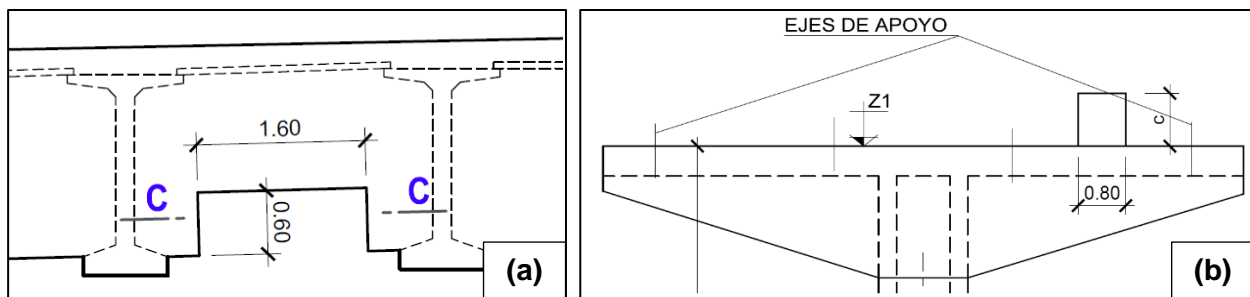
Detalles para el tope sísmico mostrados en los planos del proyecto. (a) Detalle de la viga diafragma en la zona donde se coloca el tope sísmico. (b) Detalle que muestra el ancho del tope sísmico sobre la pila.
